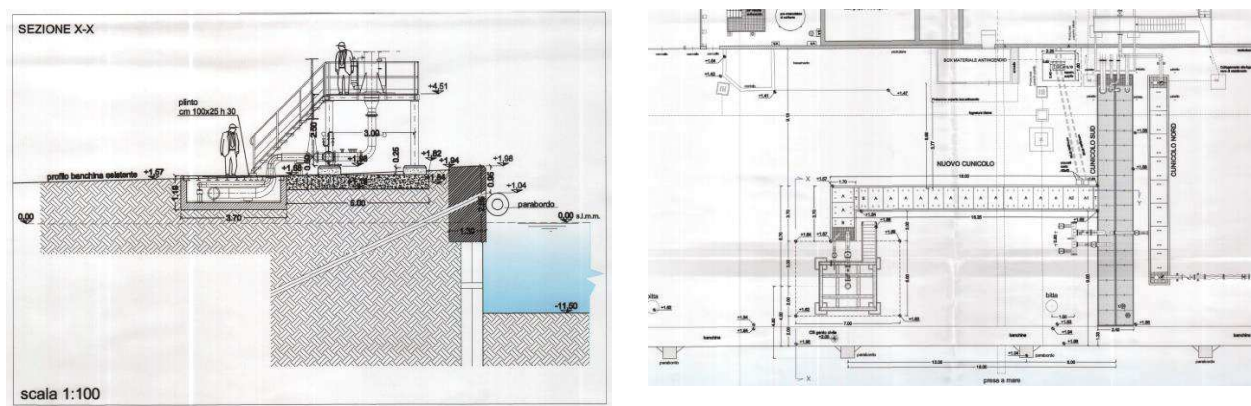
Sezione e planimetria del braccio meccanico da rimuovere (Attività esclusa dal presente appalto).
